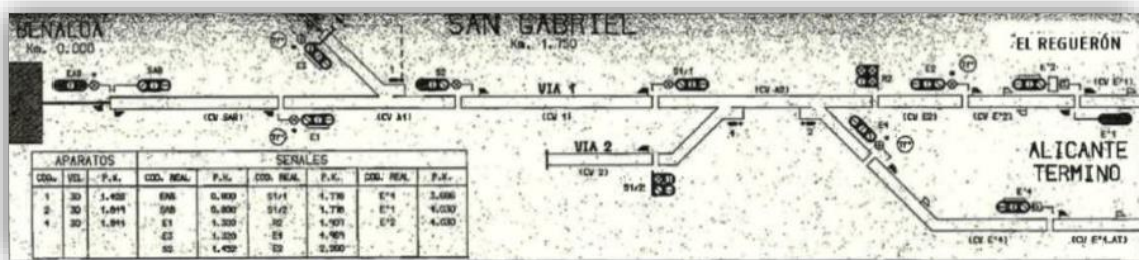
Esquema instalación Apartadero de San Gabriel y acceso al Puerto de Alicante.
